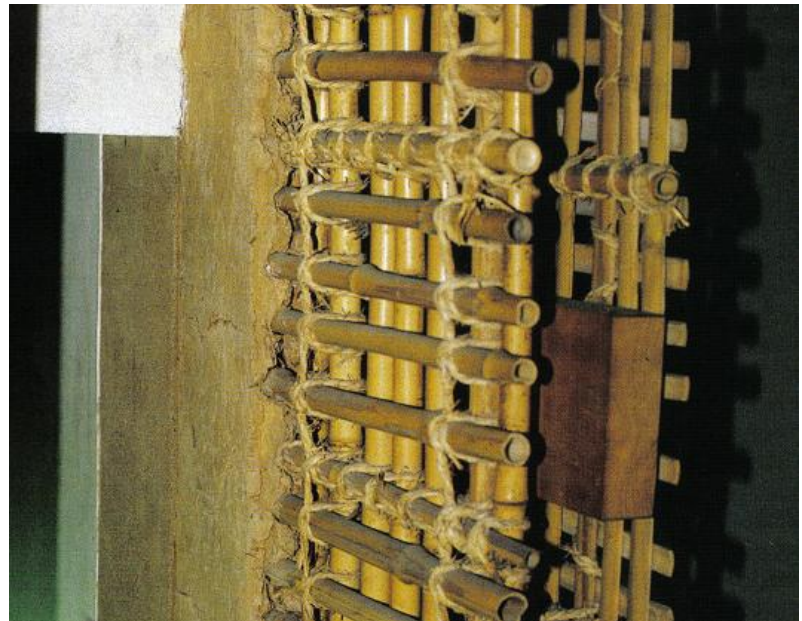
Estrutura em bambu amarrado e coberto de barro para melhor proteger contra o fogo. Torre Uto do castelo de Kumamoto.
